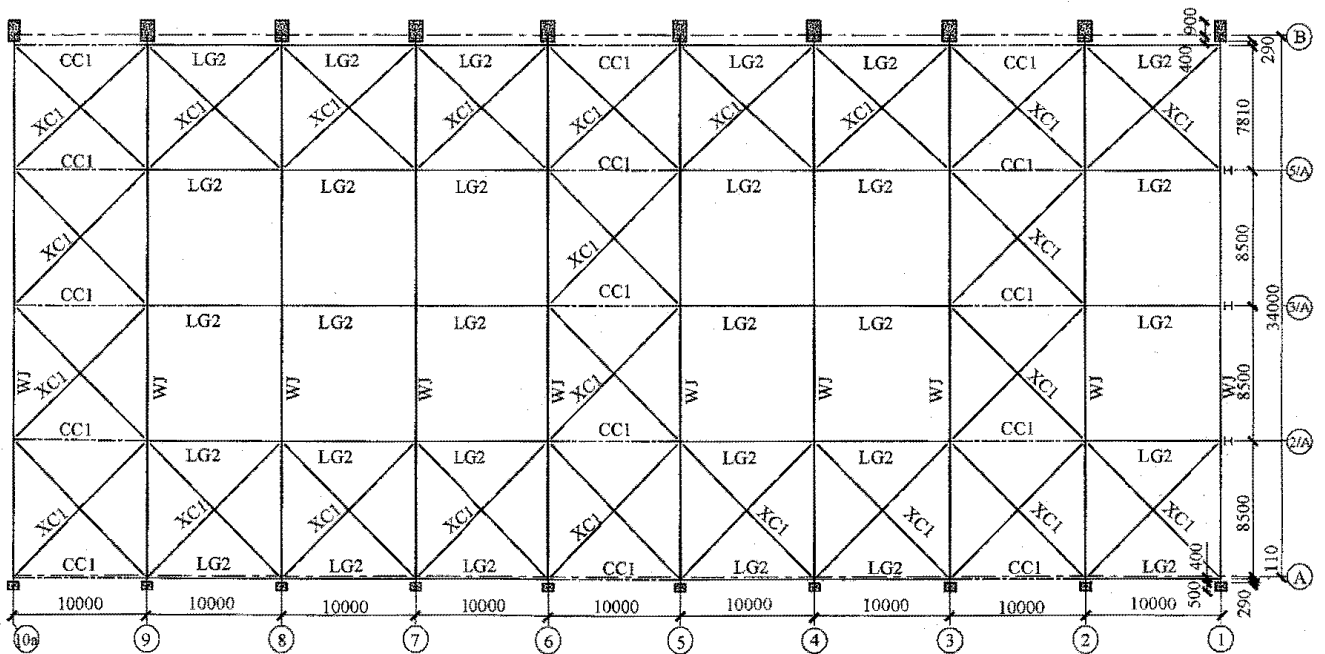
所示是某百万机组屋面支撑布置实例, 该电厂主厂房是现浇钢筋混凝土框架结构体系, 屋面钢
